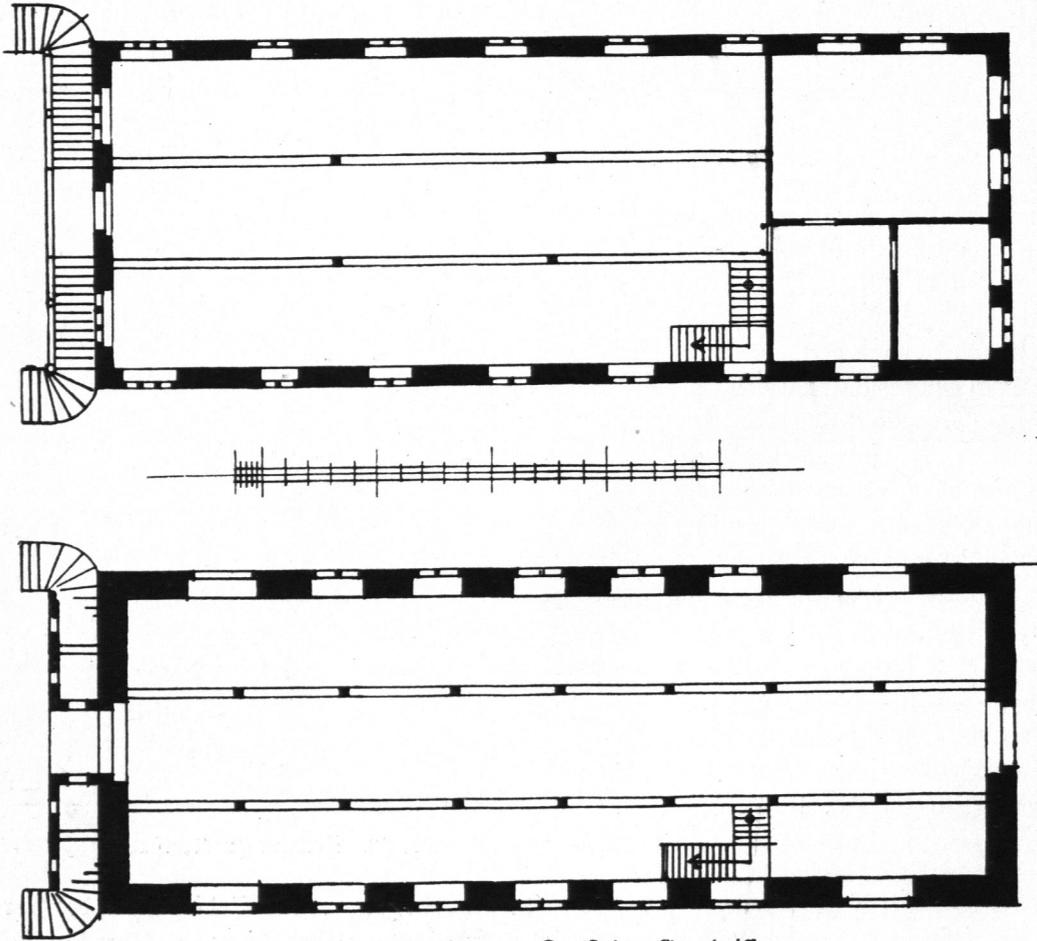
Rathaus zu Karlstadt. Grundrisse.
